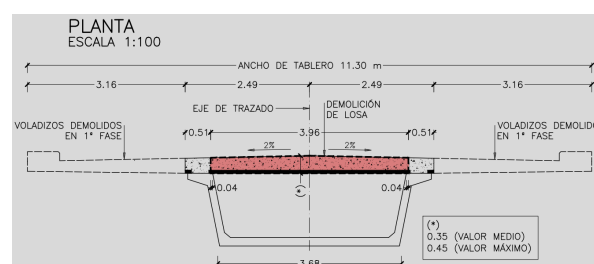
Sección transversal con esquema de piezas de losa retiradas
